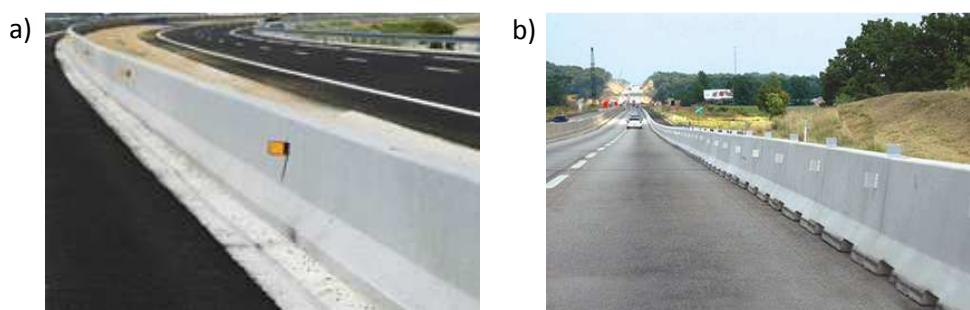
Barreras de hormigón *in situ* (a) y prefabricado (b).
